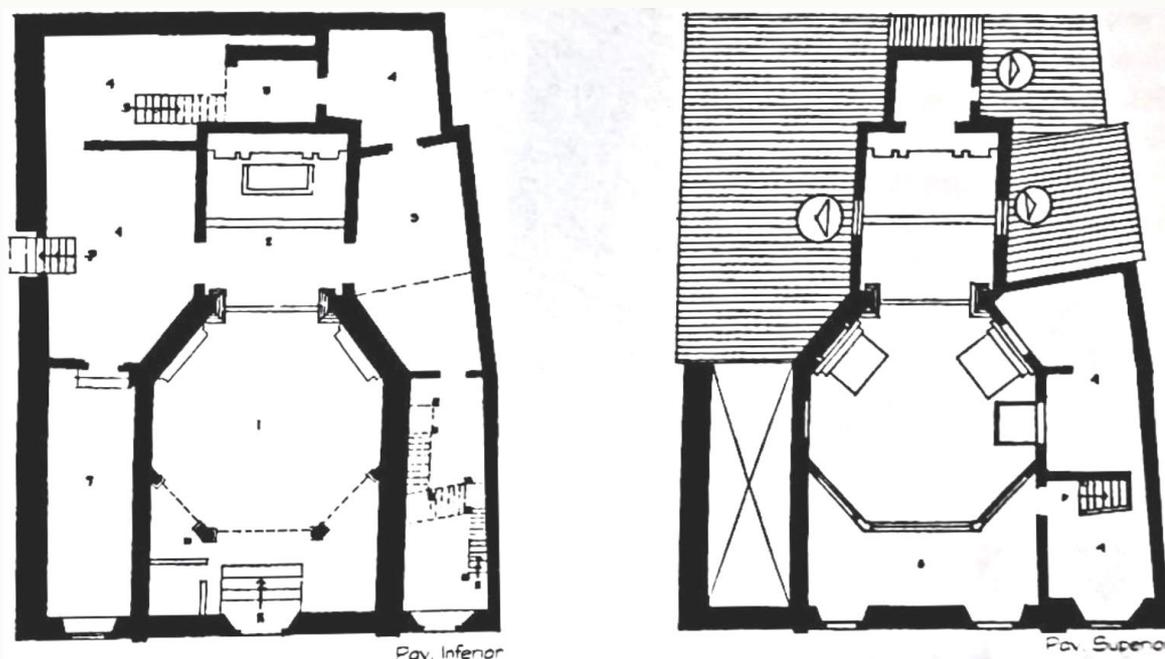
Plantas dos pavimentos inferior e superior da Igreja de Nossa Senhora do Carmo.
